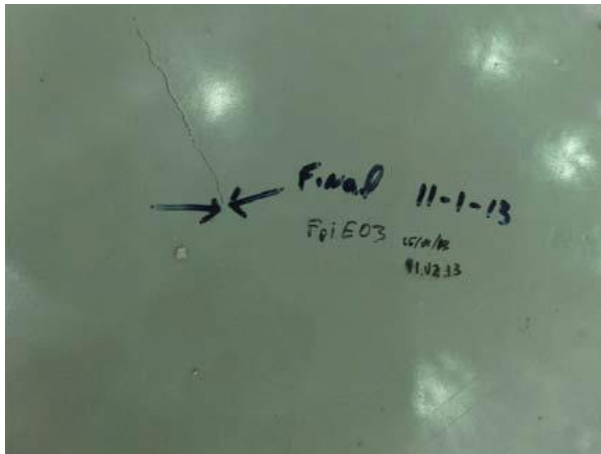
y 18. Fisuras a 45º en sala de instalaciones y fisuras en zona central del muro interior (AICEQUIP, (2013)).
